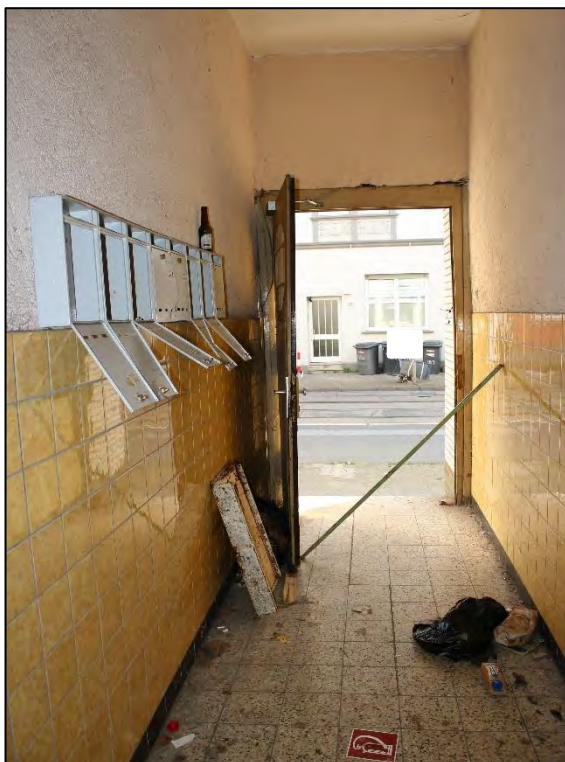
Gemeinschaftstreppehaus, Hauseingang
